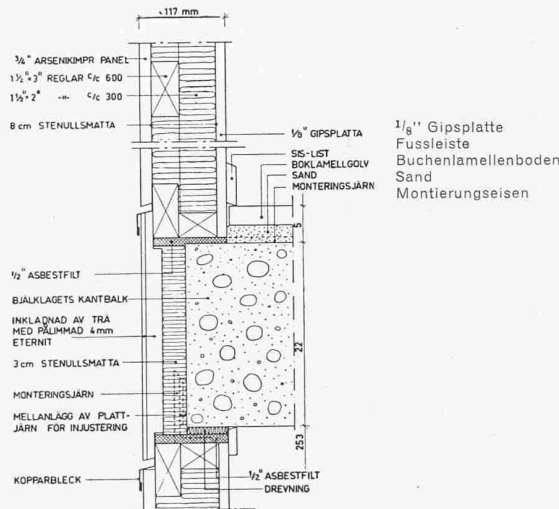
Decke mit Anschluss an das Aussenwandelement. Vertikalschnitt 1:10
